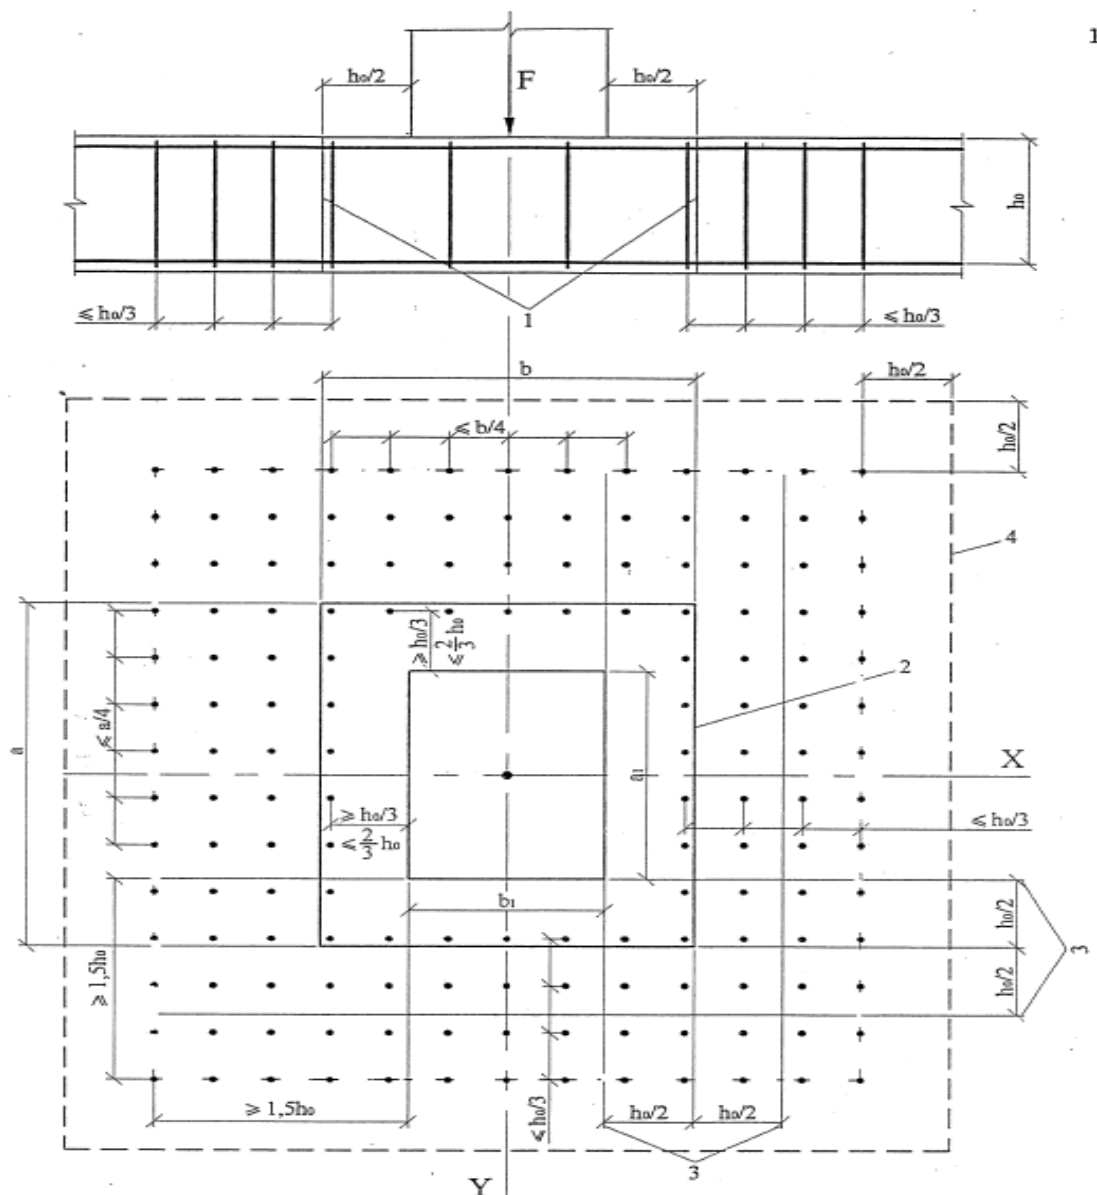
Схема для расчета железобетонных плит с вертикальной равномерной распределенной поперечной арматурой на продавливание.
